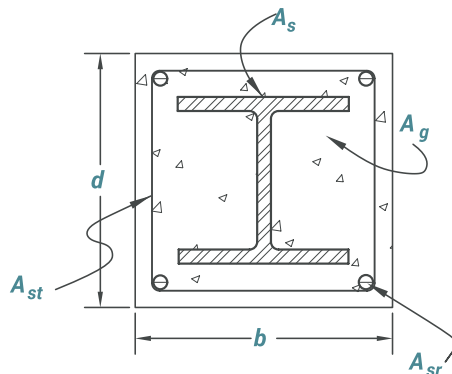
Requisitos de columnas compuestas acero-concreto. Perfiles de acero compuesto ahogados en concreto reforzado
